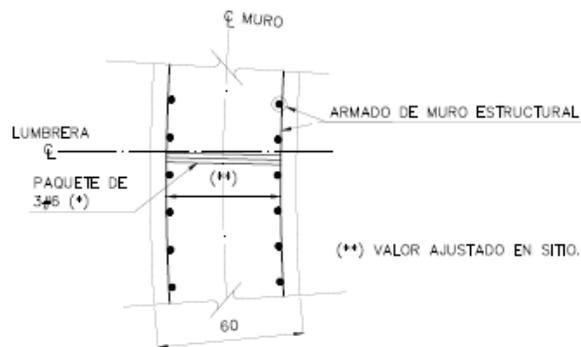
Corte D-D. Detalle de acero estructural en zona de ganchos de izaje.
